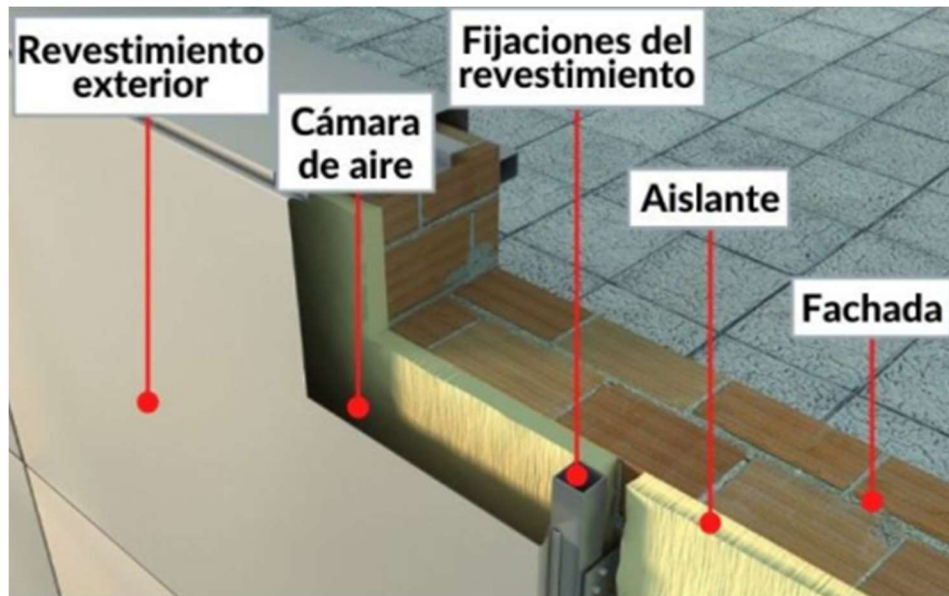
Detalle de ensamblaje de sistema de fachada ventilada
